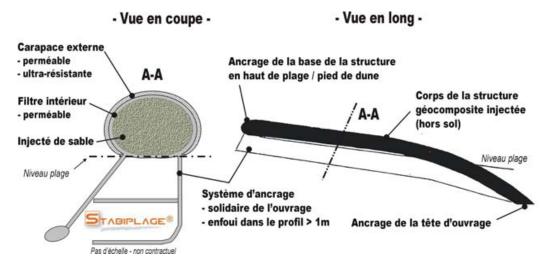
coupe transversale et longitudinale d'un Stabiplage® avec ancrage
